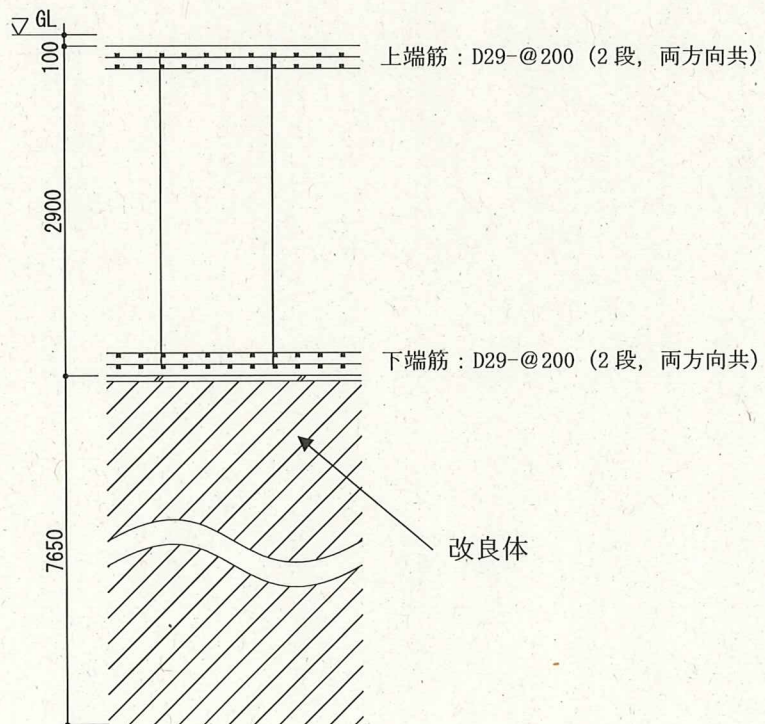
基礎配筋図 (一般部) (単位 : mm)
